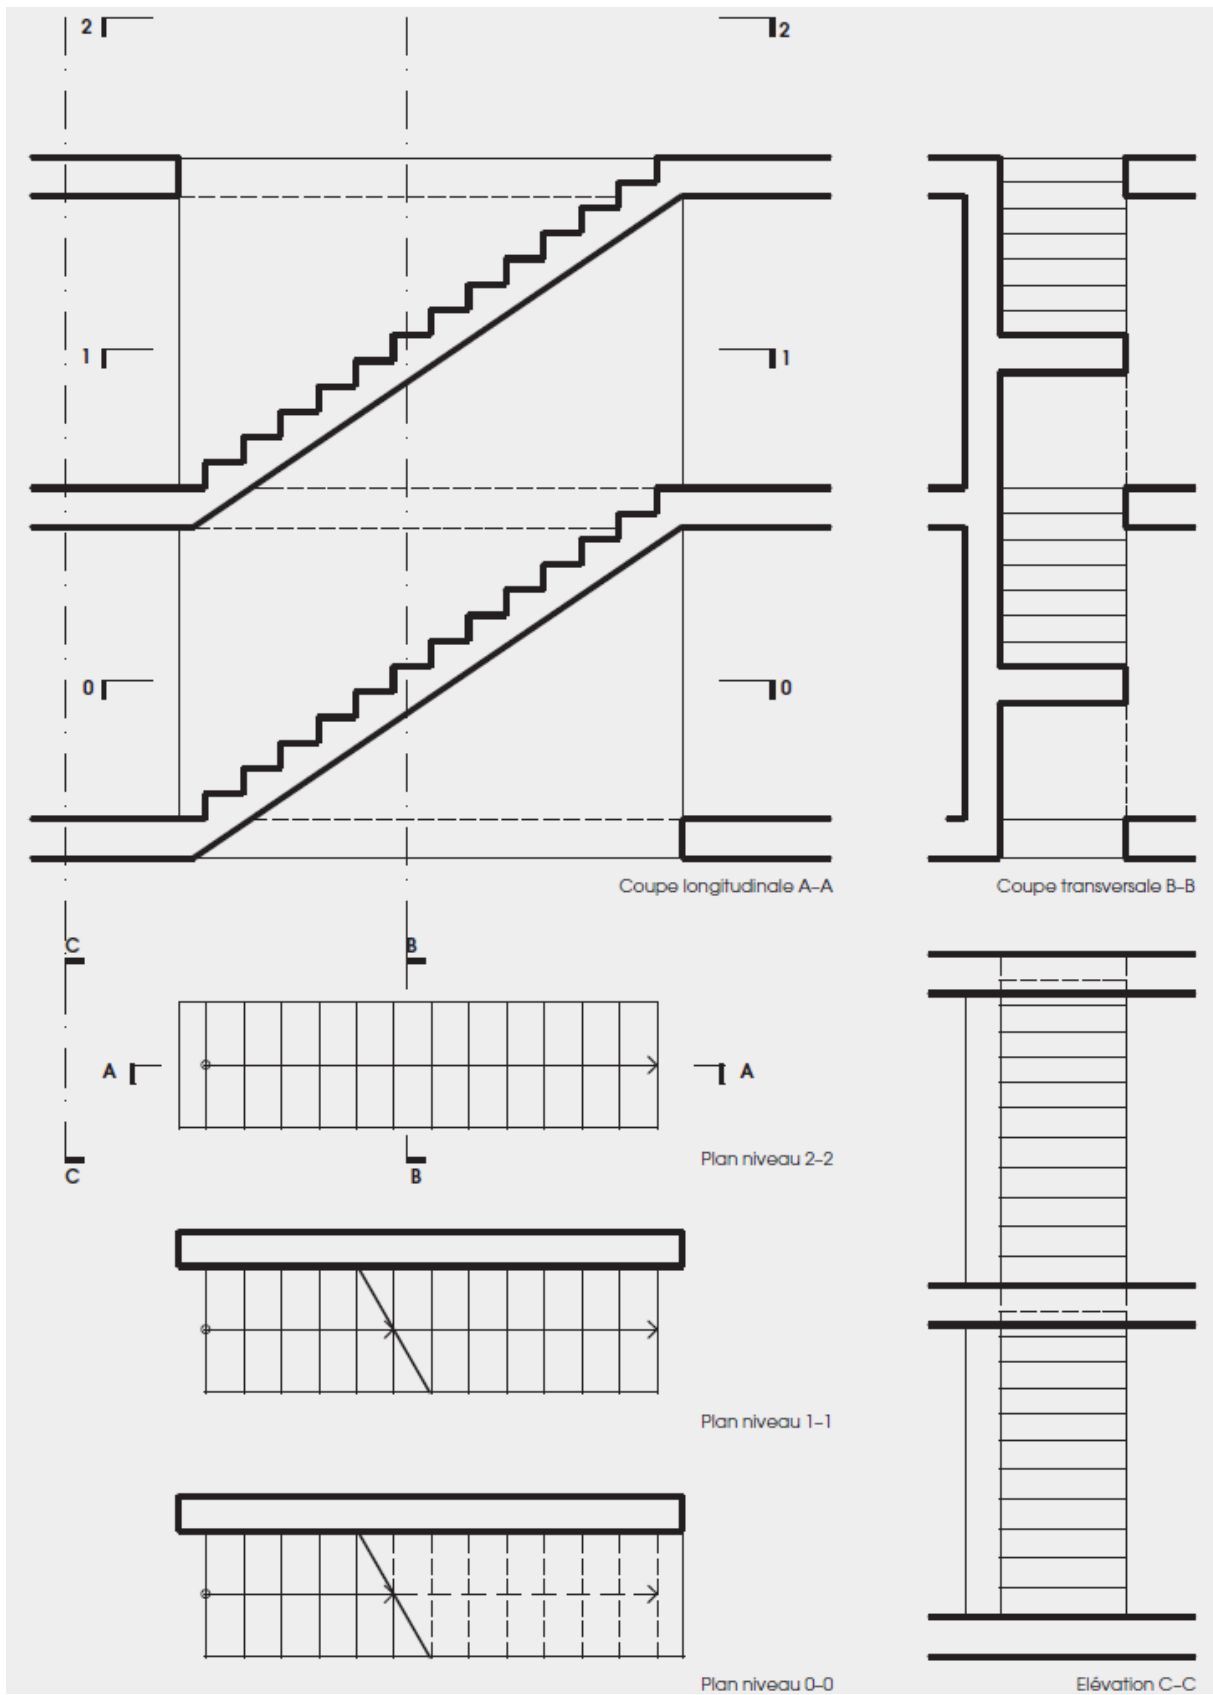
Représentation d'un escalier en plan, élévation et coupe
